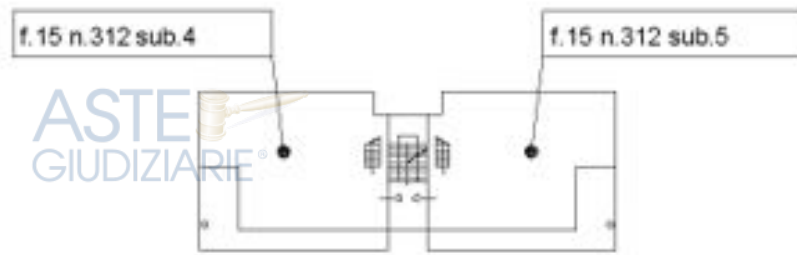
Elaborato planimetrico prot. n. TO0376726 – piano terra
